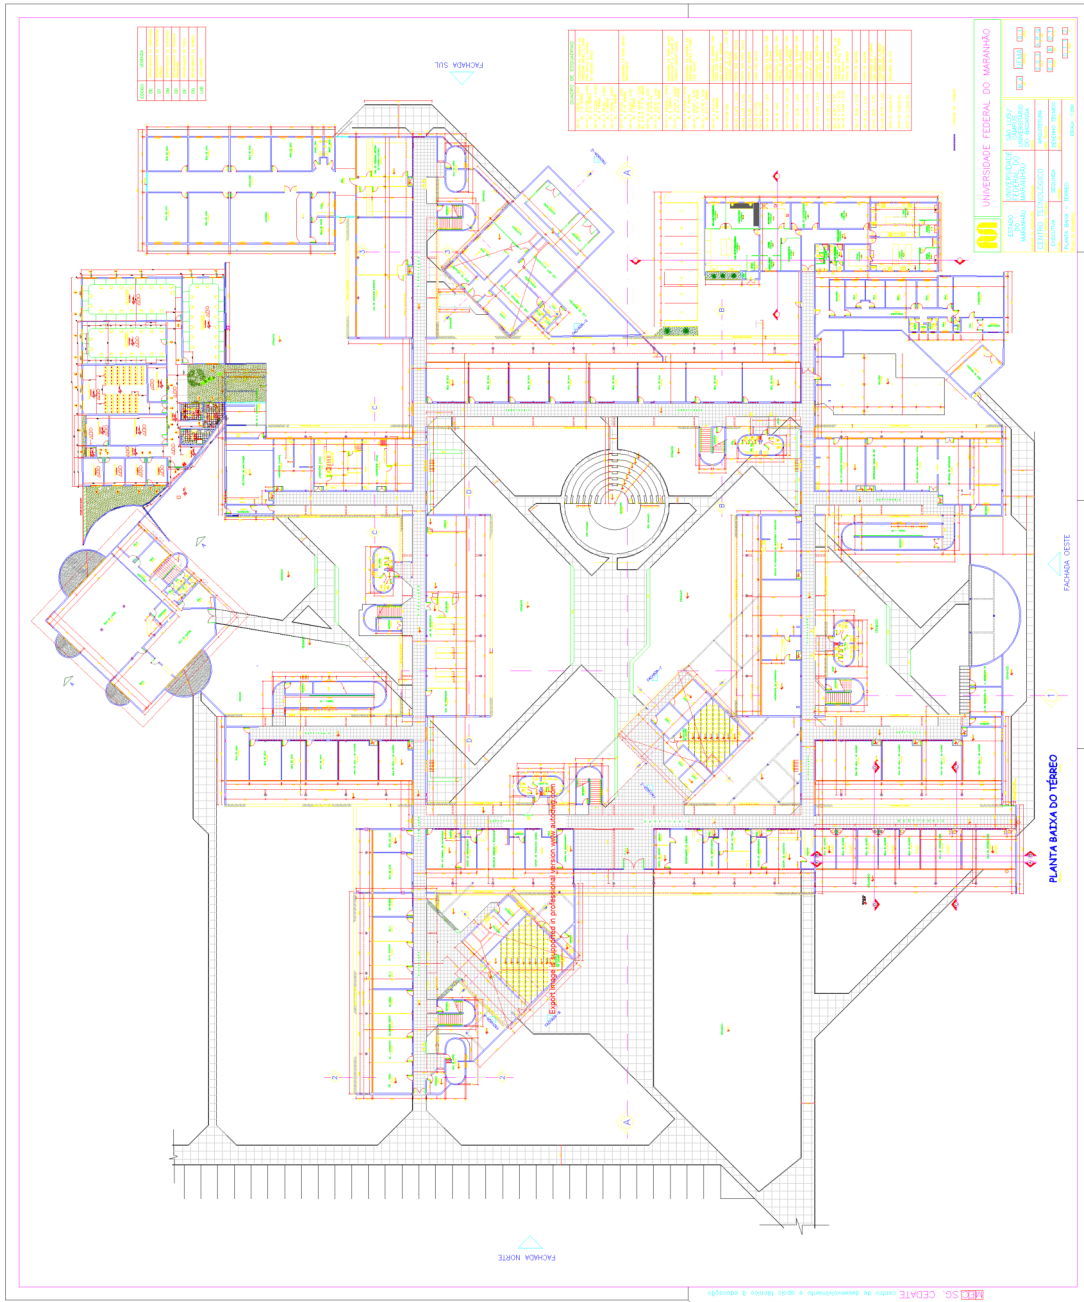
Imagem da UFMA vista de cima, planta baixa.
